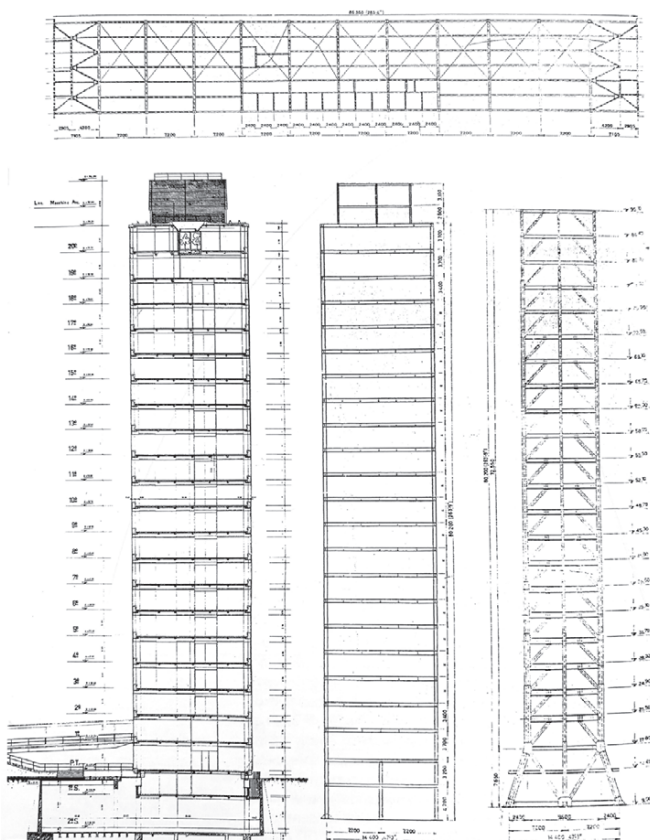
Pianta della struttura di acciaio del piano tipo, sezioni trasversali e pareti di controvento (da Acciaio, n. 1, 1962)
